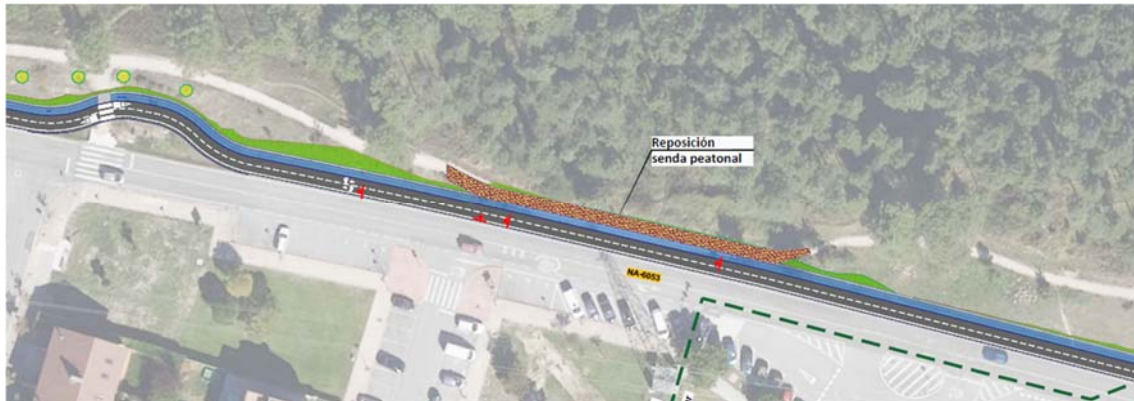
Planta - Carril bici paralelo a la carretera NA-6053
